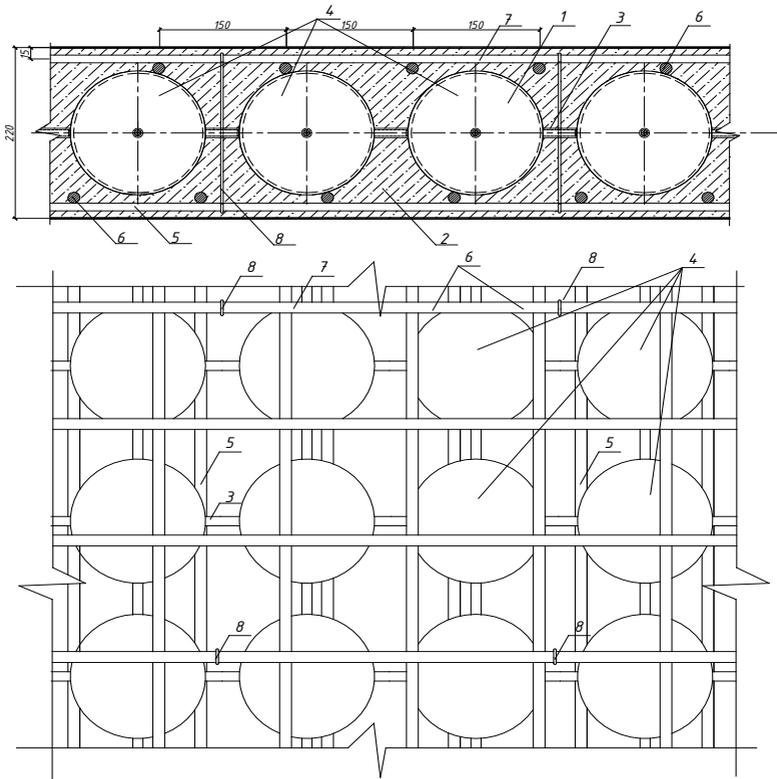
Схемы устройства пустотообразователей в плитах перекрытия; 1–пустотообразователь; 2 – плита перекрытия; 3 –фиксаторы; 4 – блок пустотообразователей; 5– нижняя арматурная сетка; 6 – арматурные стержни; 7 - верхняя арматурная сетка; 8 – хомуты.
